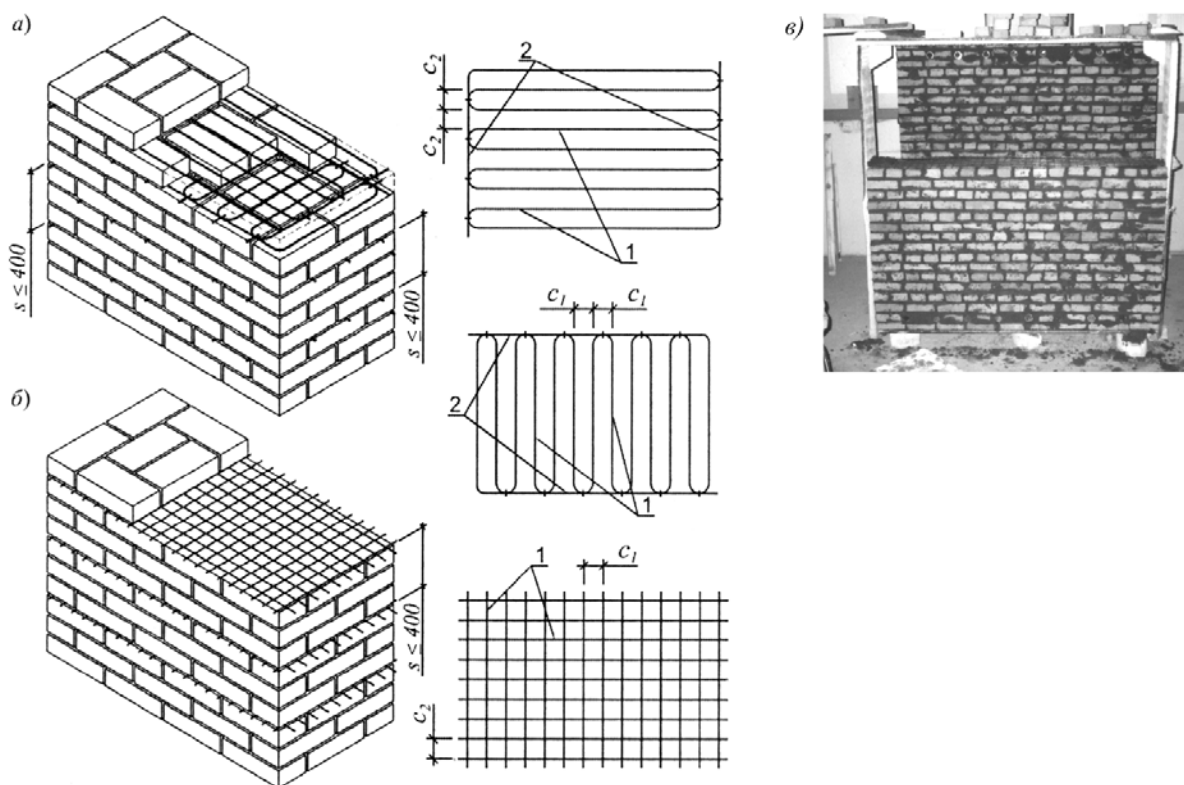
Сетчатое армирование каменных конструкций:
